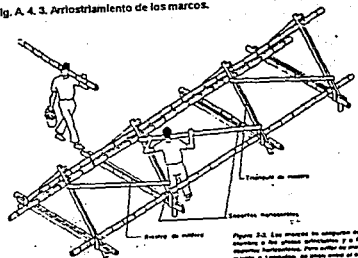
Los marcos se arriostran con el sistema de las vigas triangulares y se apoyan sobre columnas de bambú. Para cubrir el área anterior al aula, se construye un sobre techo de dos aguas con el sistema de bambú y se hace un alero de protección.
